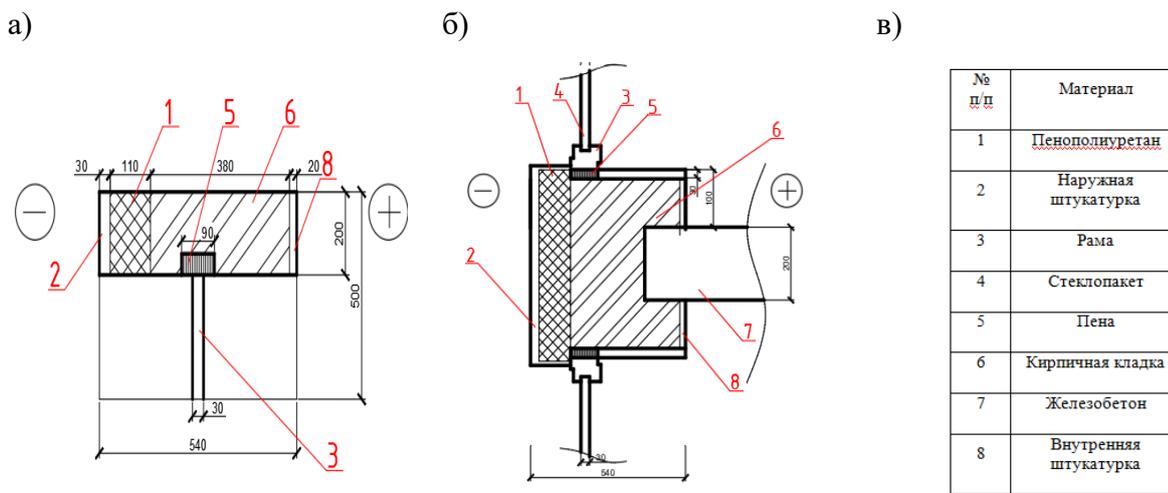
Схемы тепловых неоднородностей, участвующих в расчете: а) узел крепления стеклопакета к стеновой конструкции; б) разрез стены (по вертикали) в зоне расположения светопроемов с оконными блоками; в) спецификация
